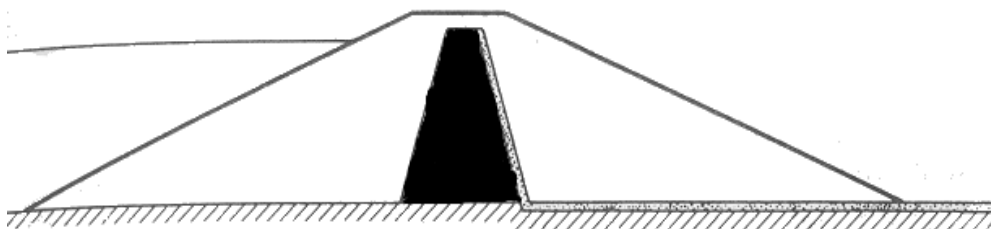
Perfil transversal zonado com filtro chaminé e dreno (Santana, 2015).
